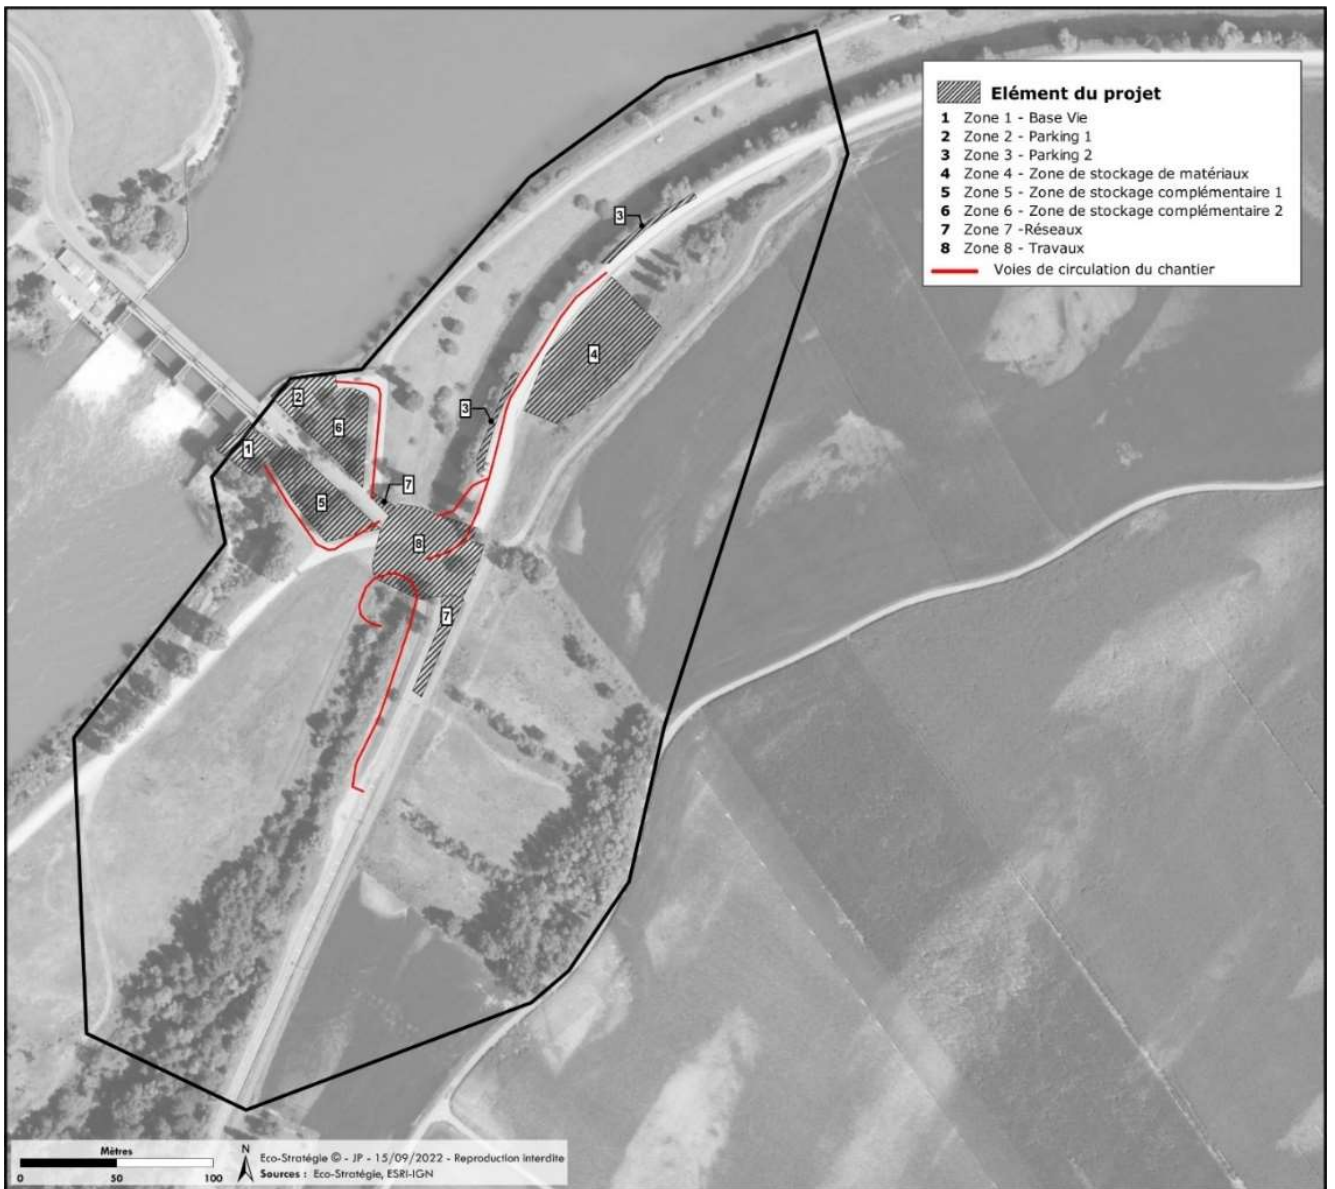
Plan de chantier détaillé – Emprise travaux.
